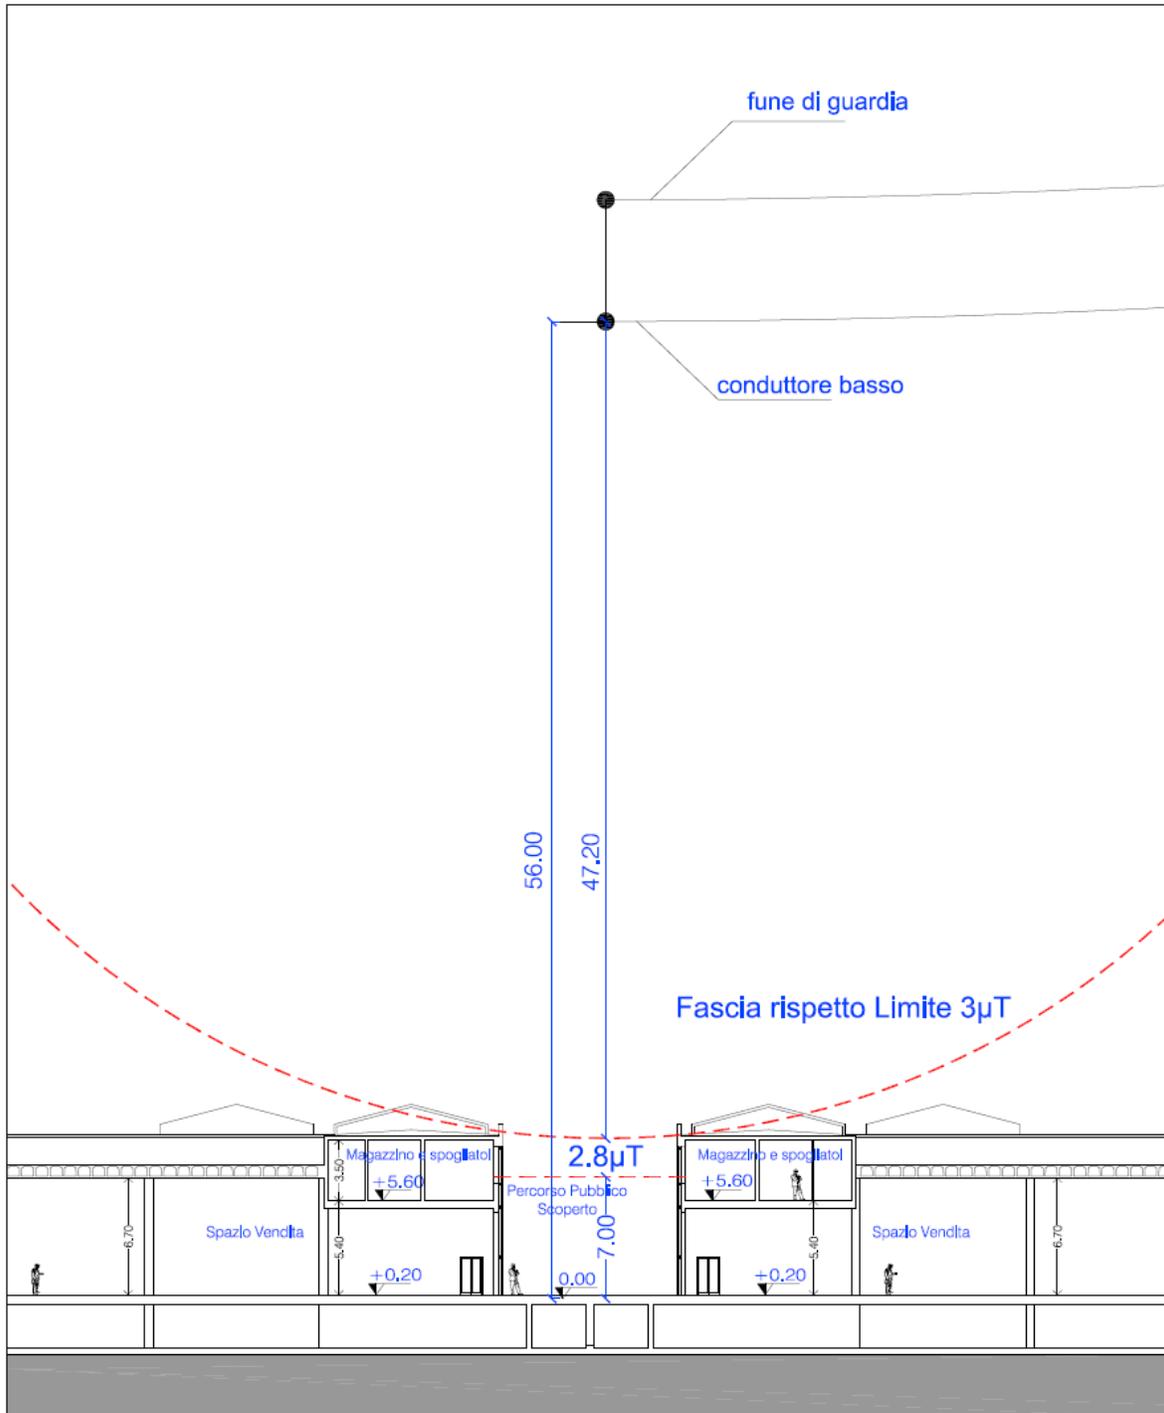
Parco commerciale, sezione B-B' (stralcio),
